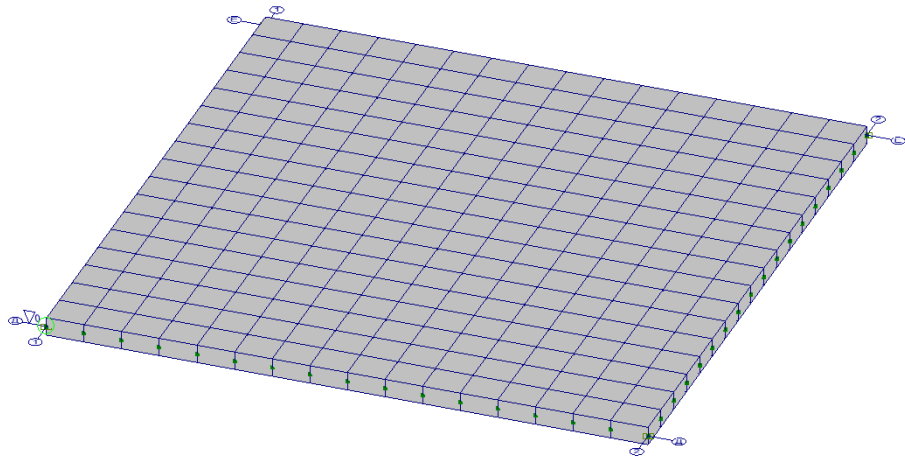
Расчетная схема плиты перекрытия в пространстве
